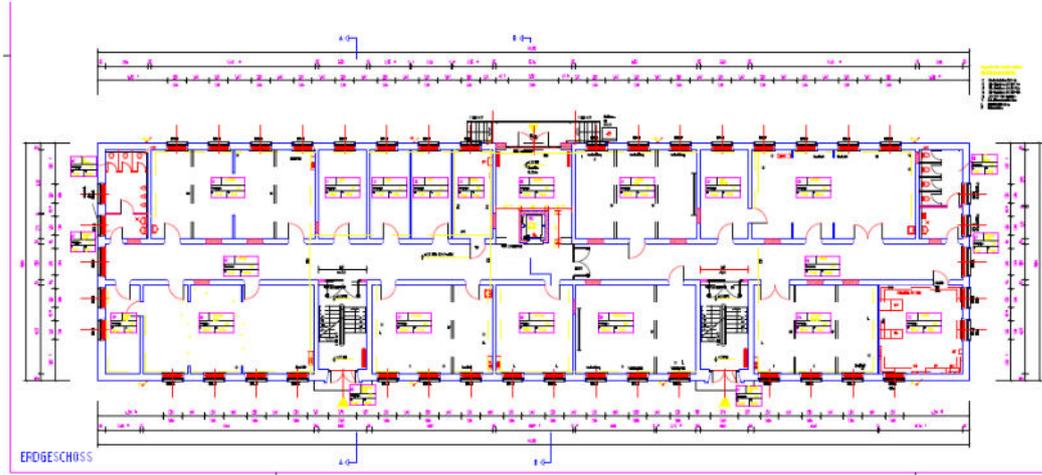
Grundrissplan Erdgeschoss, Gebäude FC
